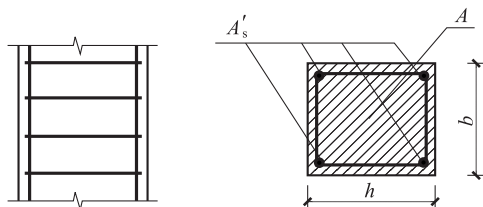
配置箍筋的钢筋混凝土轴心受压构件
